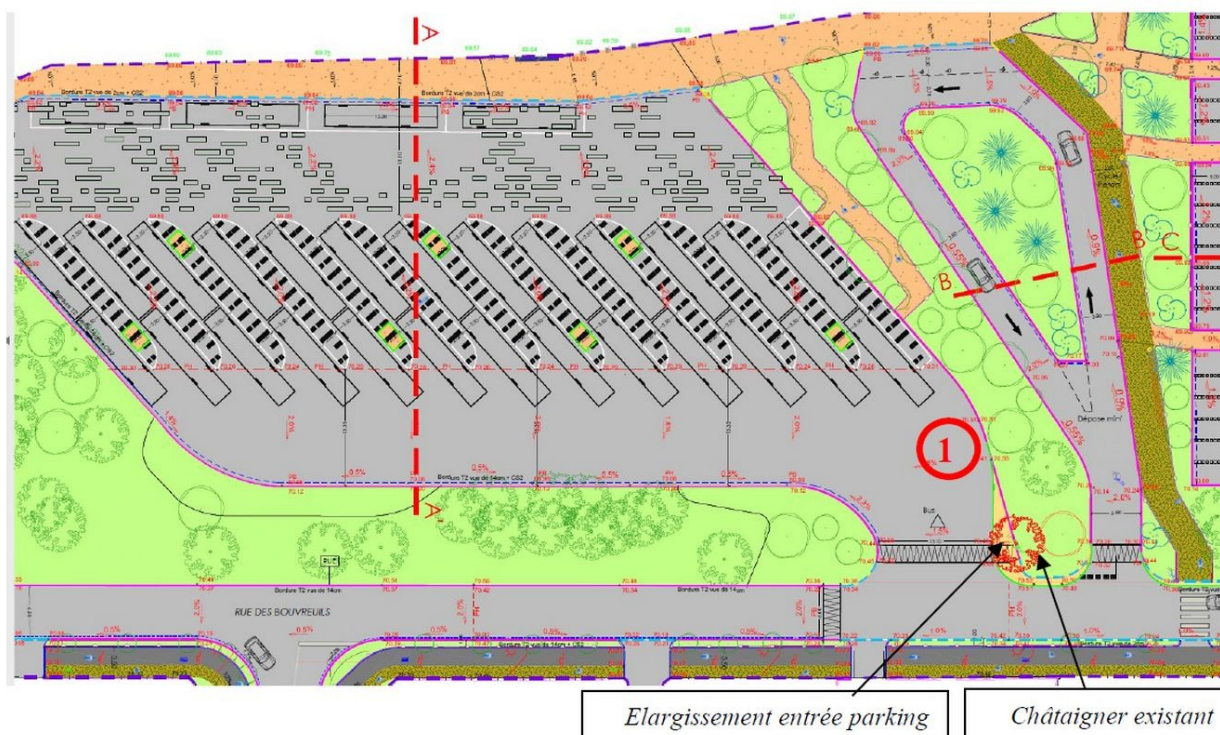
Zone boisée conservée (en vert) au niveau du parking, le long de la rue des Bouvreuils
